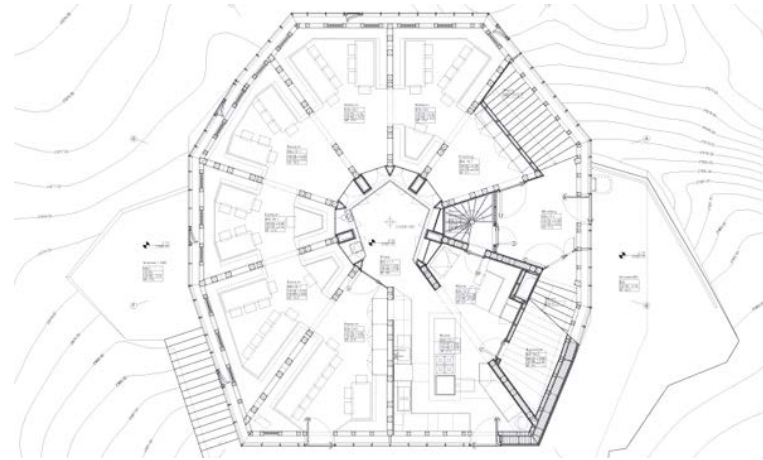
Pianta piano terra del Monte Rosa Hütte
